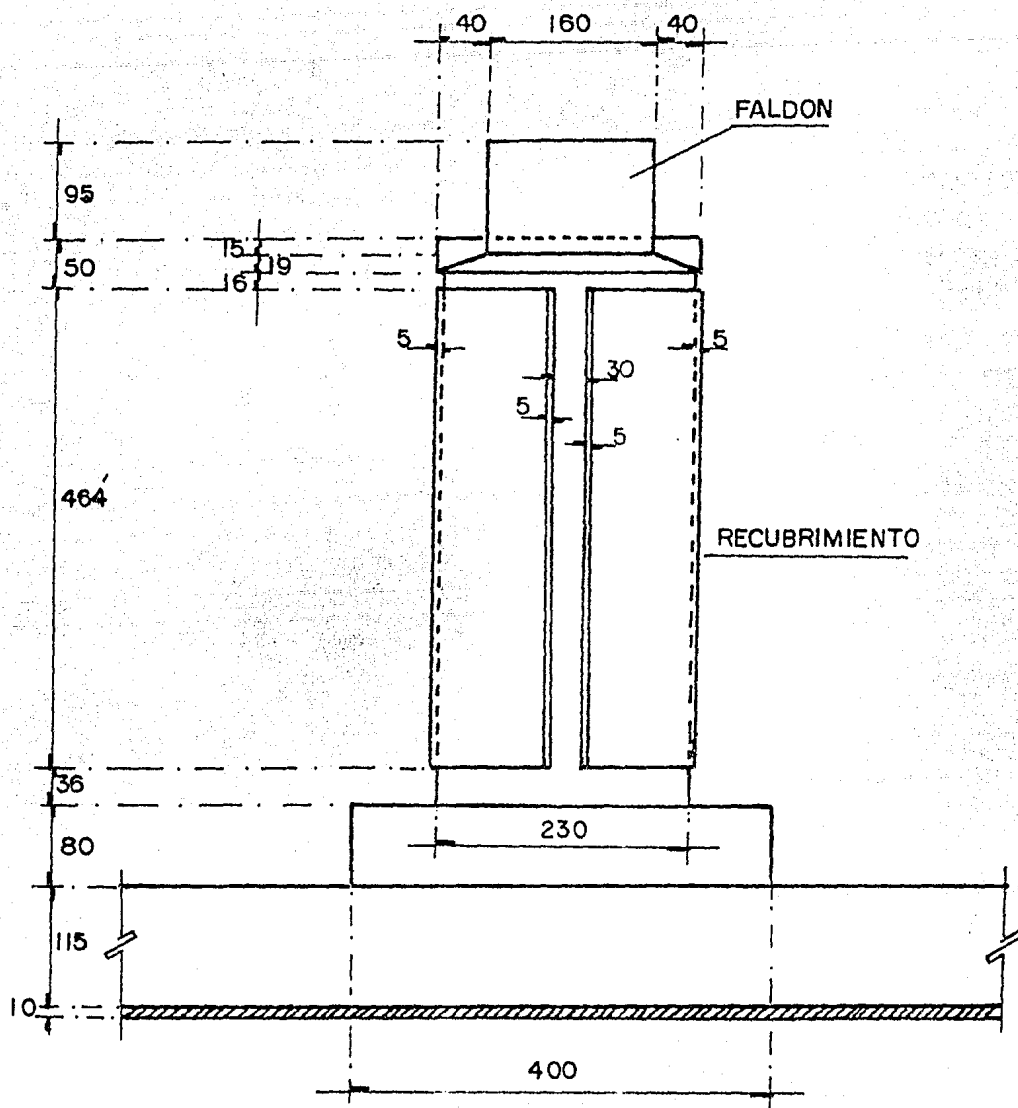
VISTA LATERAL DE LA COLUMNA
